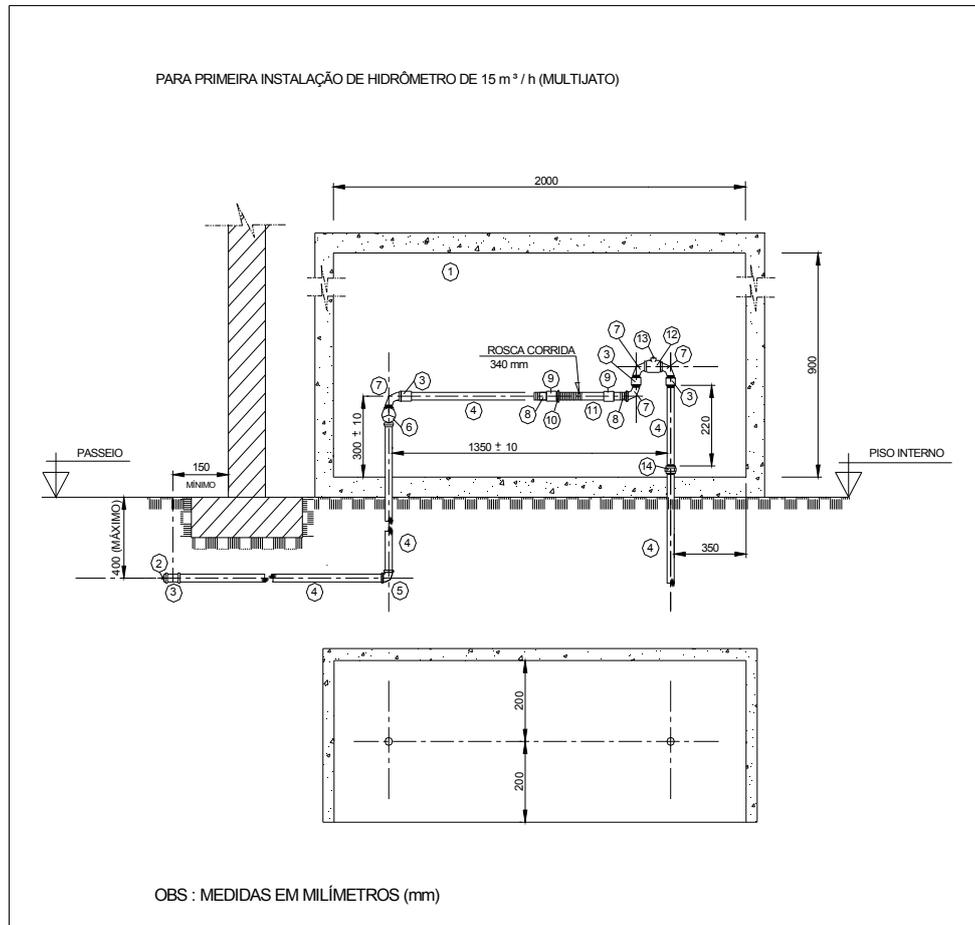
Instalação com abrigo e cavalete de ferro galvanizado DN 32
